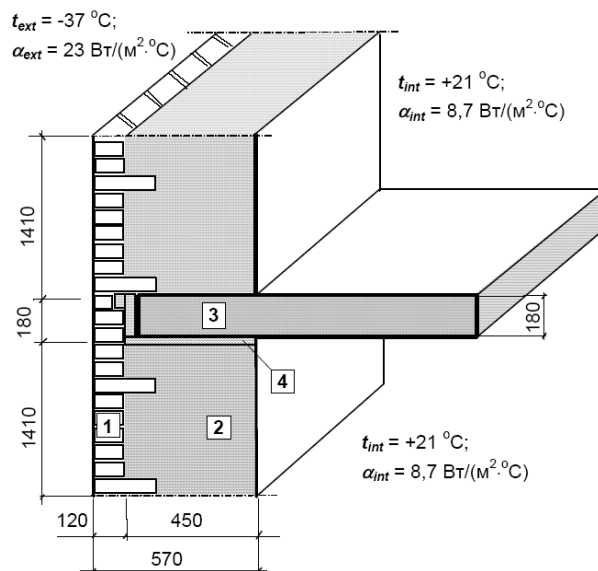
Конструктивное решение наружной стены: 1 – кирпичная кладка из обыкновенного глиняного кирпича; 2 – кладка из полистиролбетонных блоков; 3- железобетон; 4- пенополистирол
